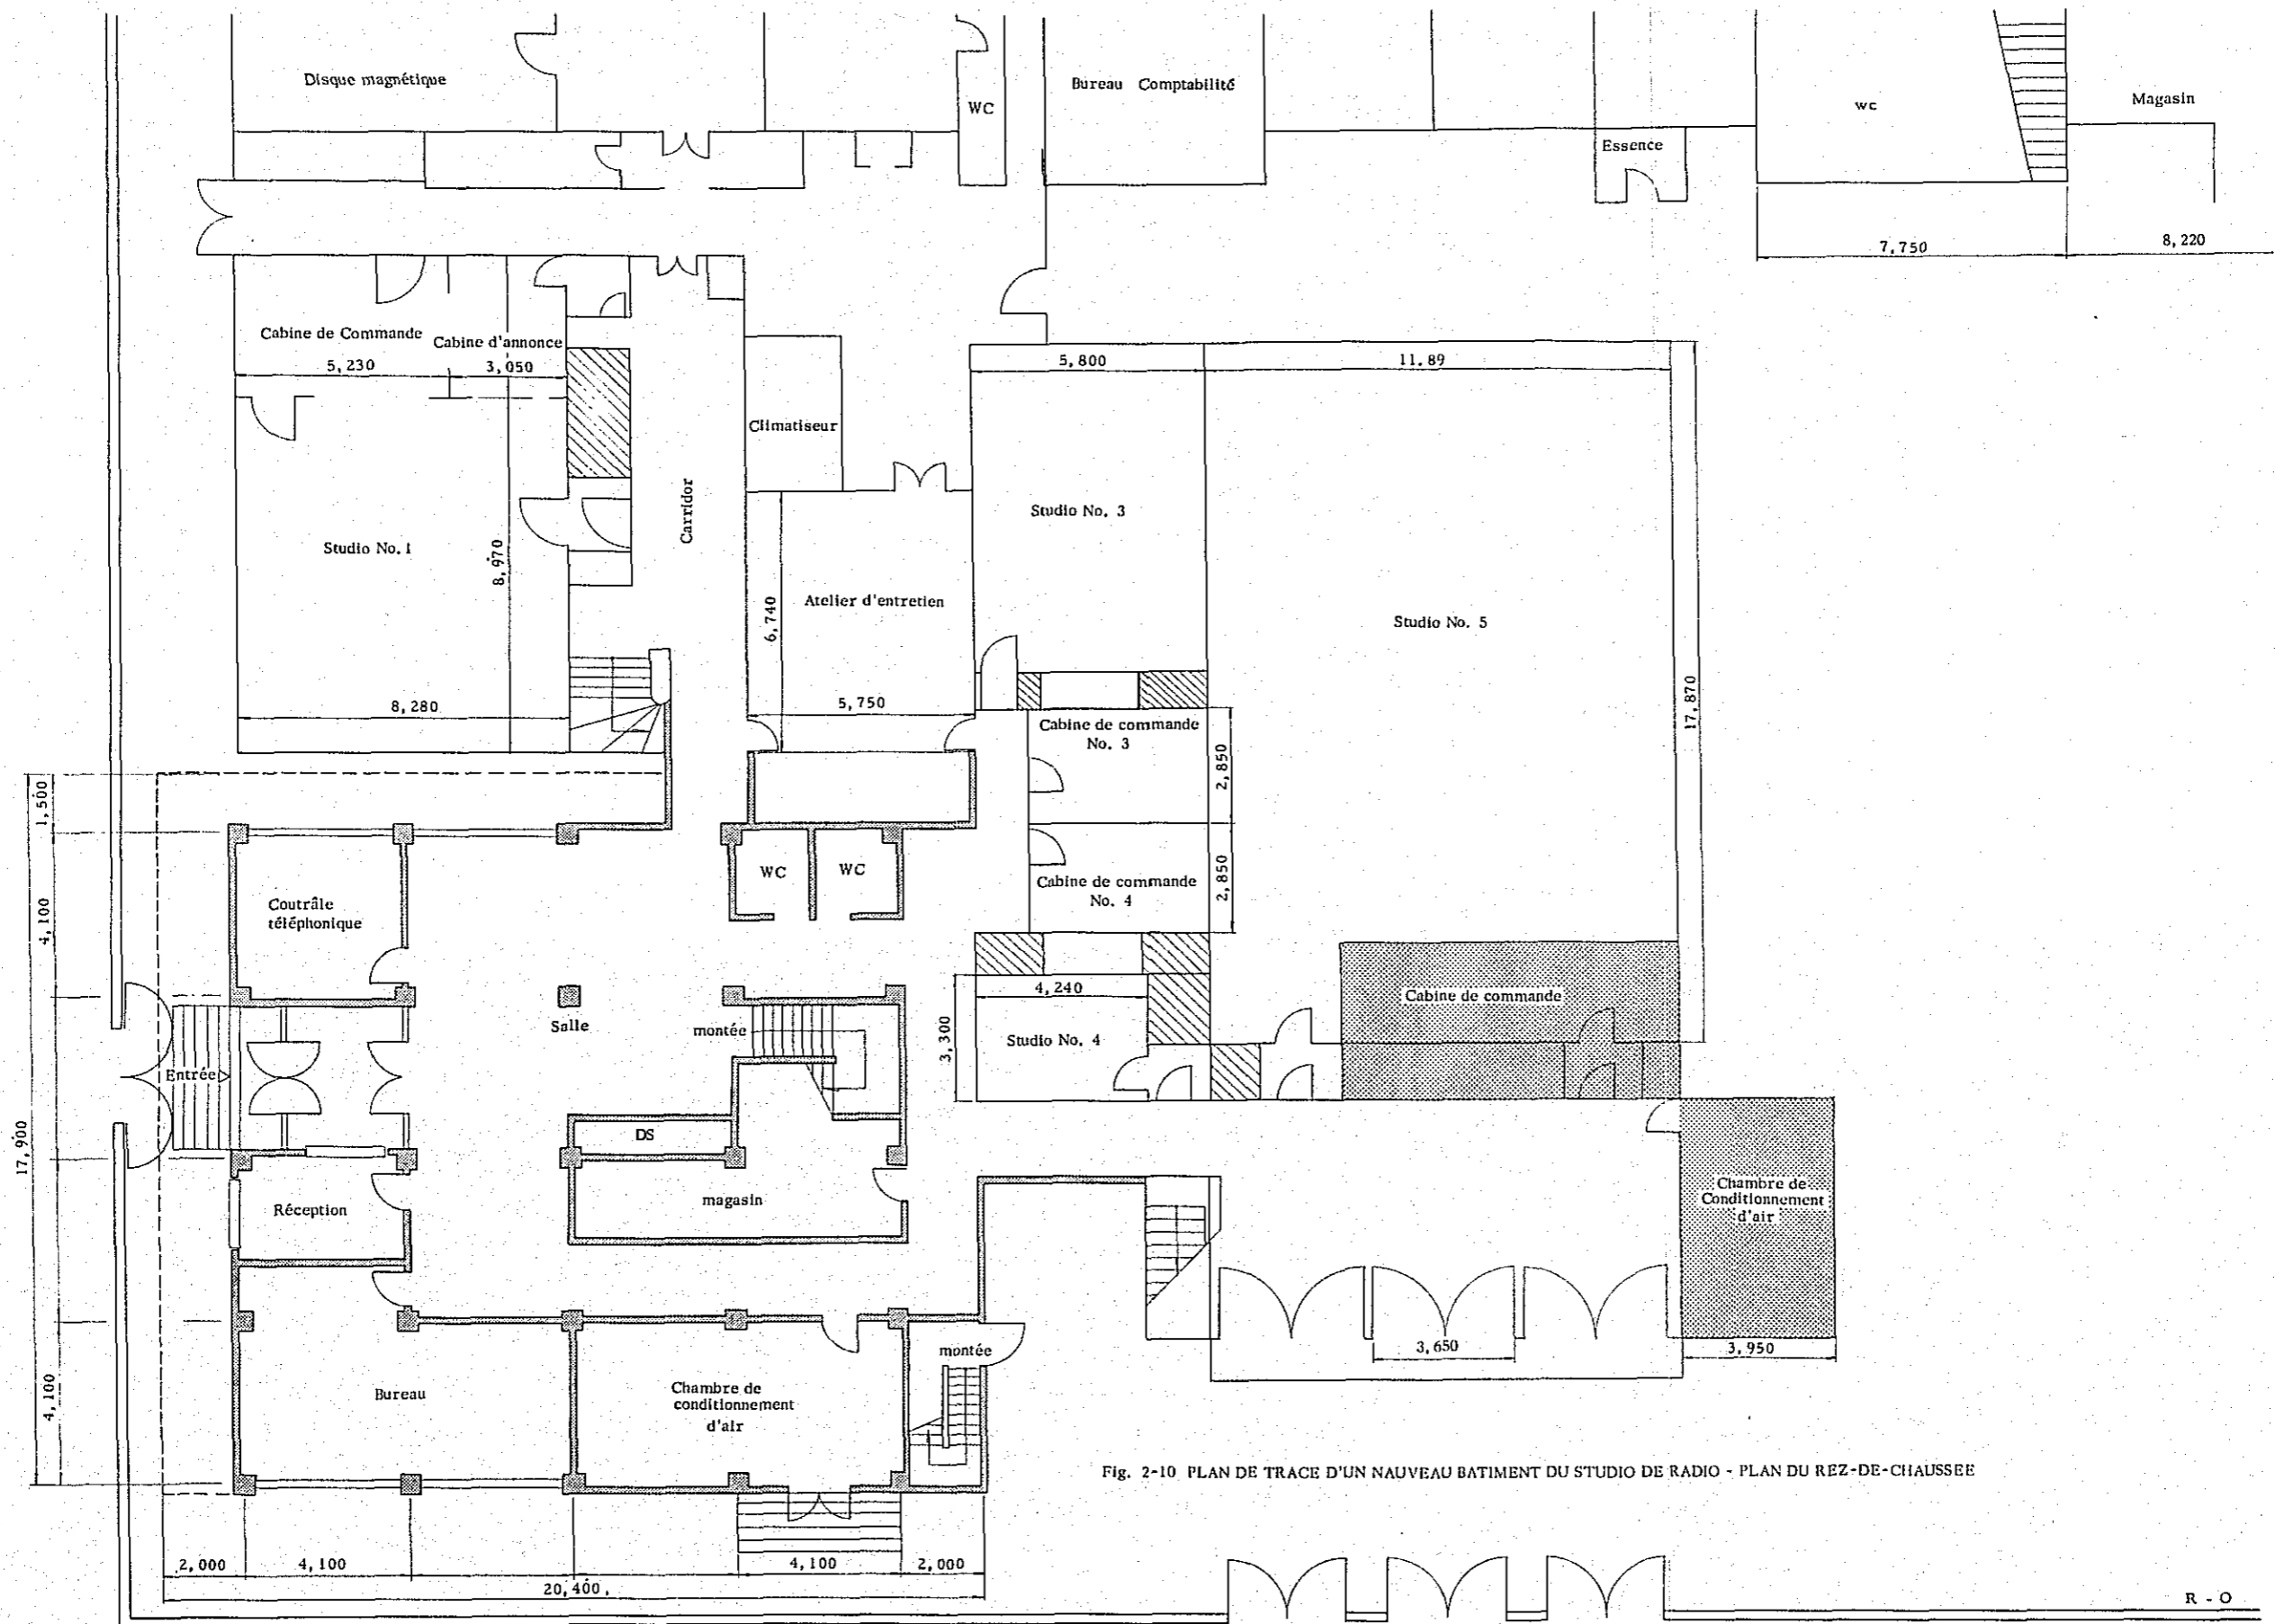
PLAN DE TRACE D'UN NOUVEAU BATIMENT DU STUDIO DE RADIO - PLAN DU REZ-DE-CHAUSSEE
